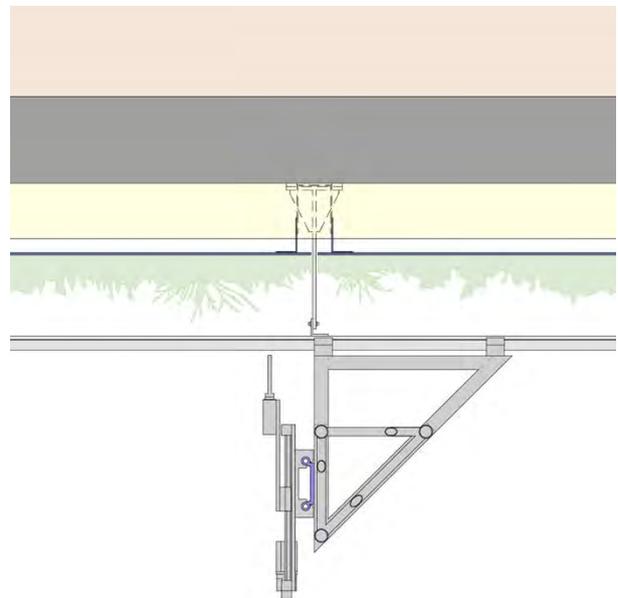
Travensystem (Dreieck-Gitterträger) (Horizontalschnitt Fassade M 1:50 / Verkleinerung). Bild: Fakultät Architektur
